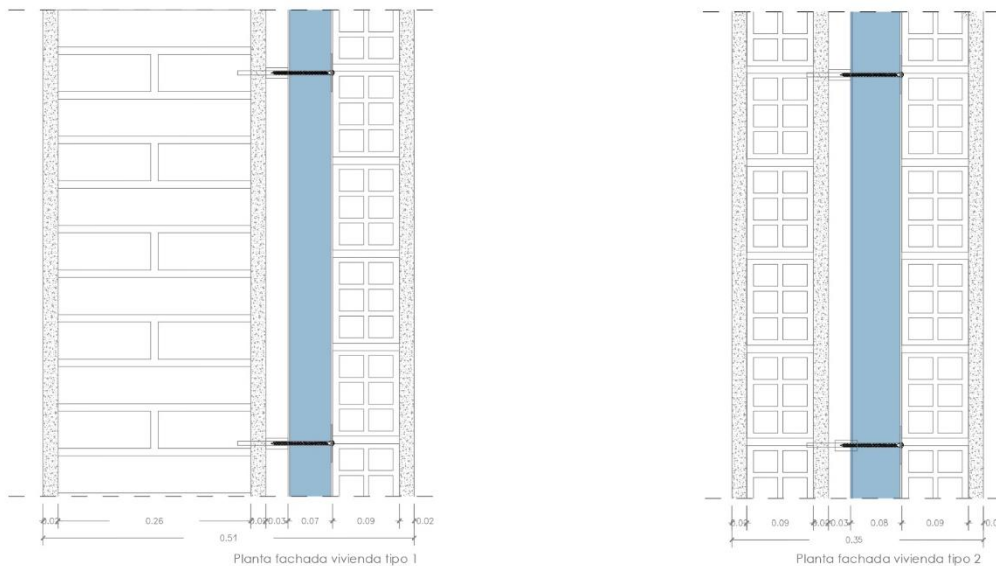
Planta del sistema vivienda tipo 1 y tipo 2 para la ciudad de Valdivia. Se adjuntan especificaciones en Anexo (Detalle tipo solución 2, varía el espesor de aislamiento). Fuente: Creación propia.
